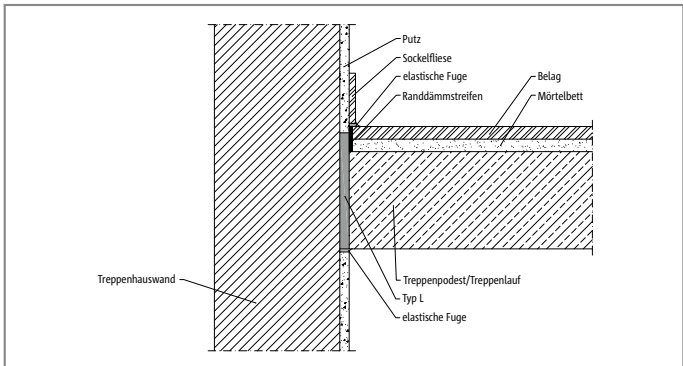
Schöck Tronsole® Typ L: Einbauschnitt Ortbetontreppe
